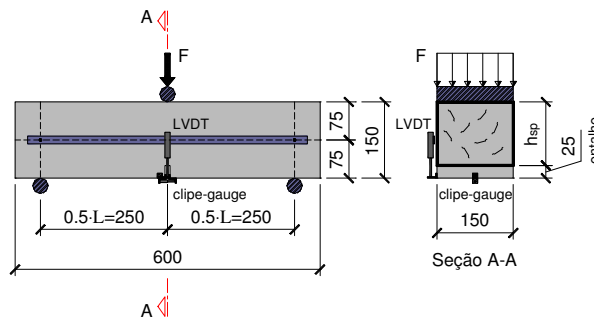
Ensaio de flexão em três pontos em viga entalhada (dimensões em mm)
